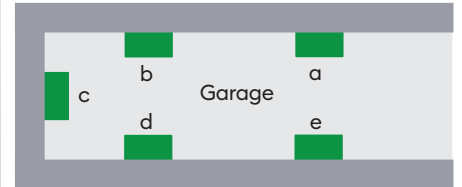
a - e : Options de montage de la Wallbox sur le mur du garage.
